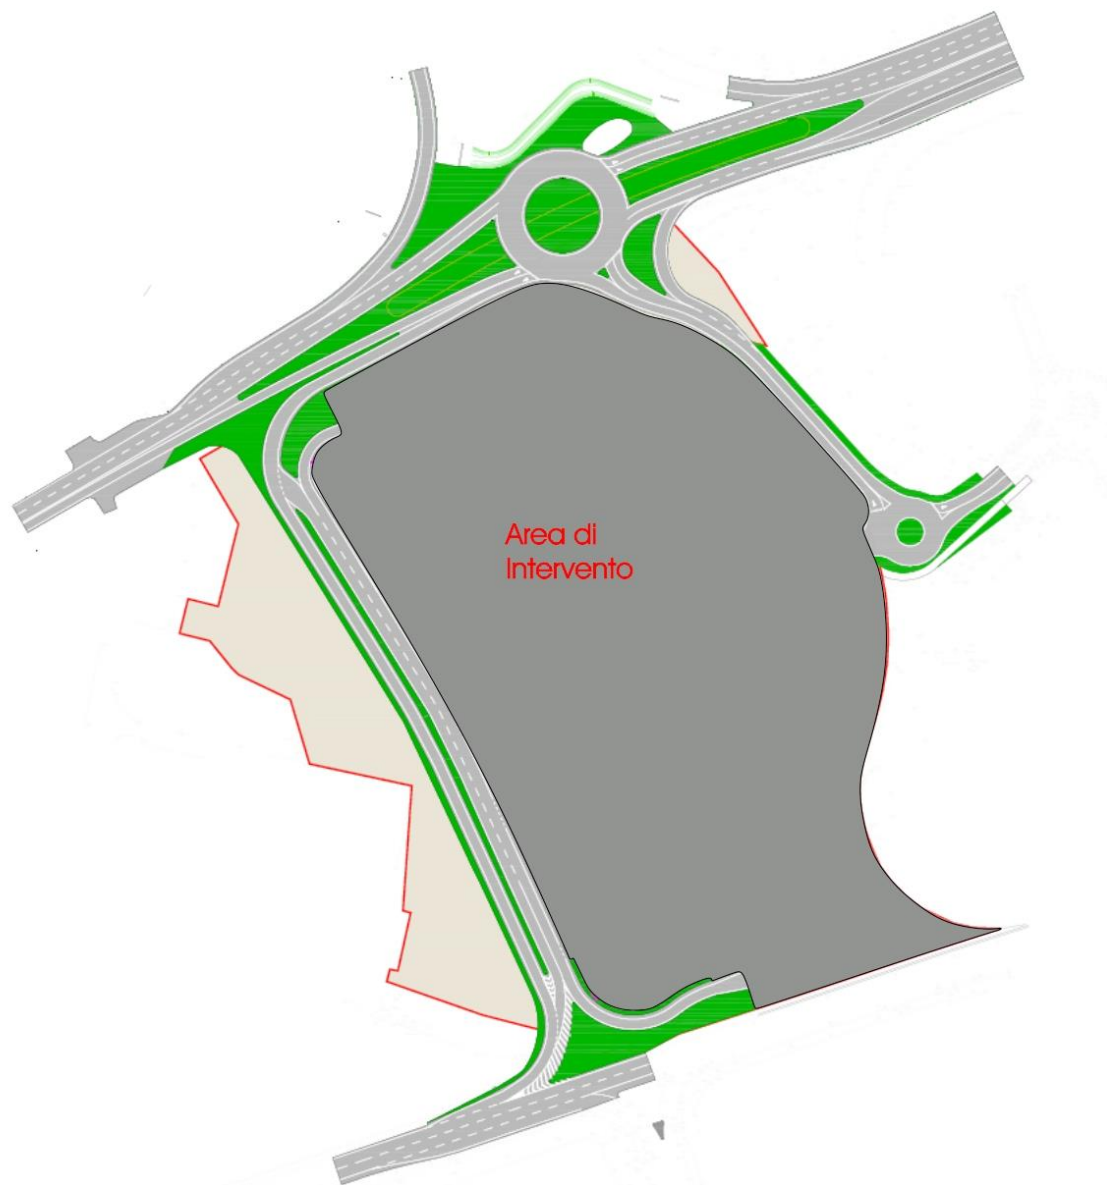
Interventi viabilistici previsti – Ipotesi 1 – Planimetria di progetto
